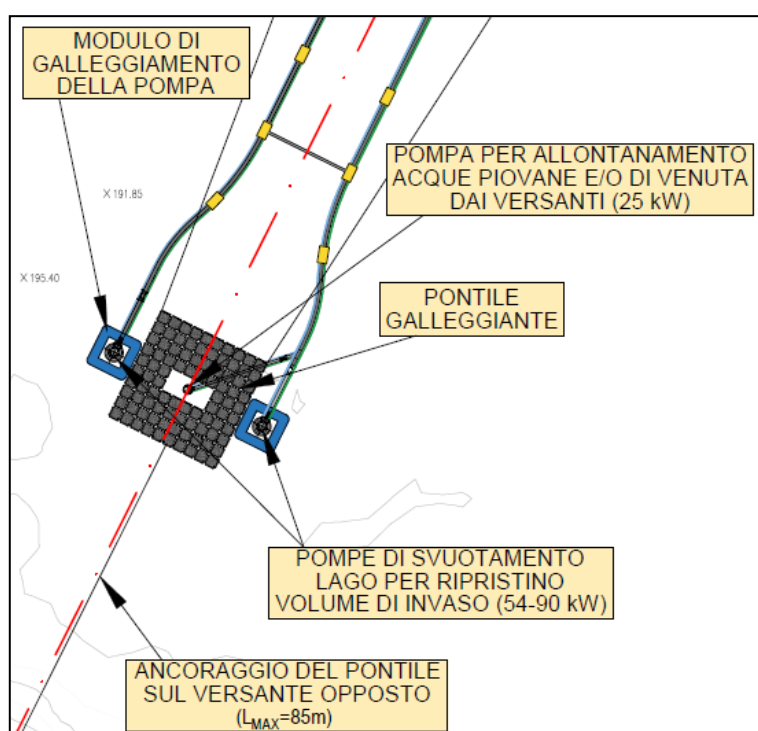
Stralcio planimetrico del pontile galleggiante al quale saranno ancorate le pompe
